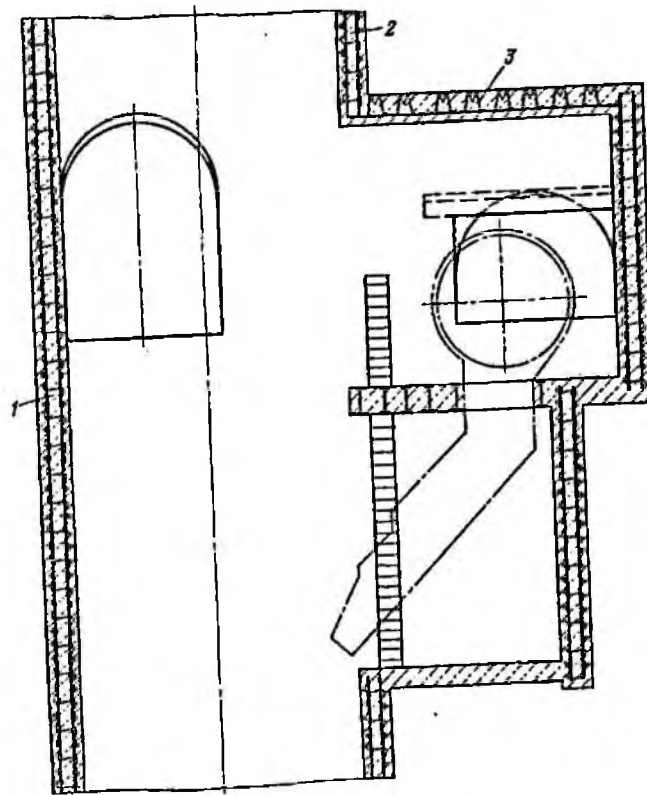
Бункерная камера с железобетонной крепью:
